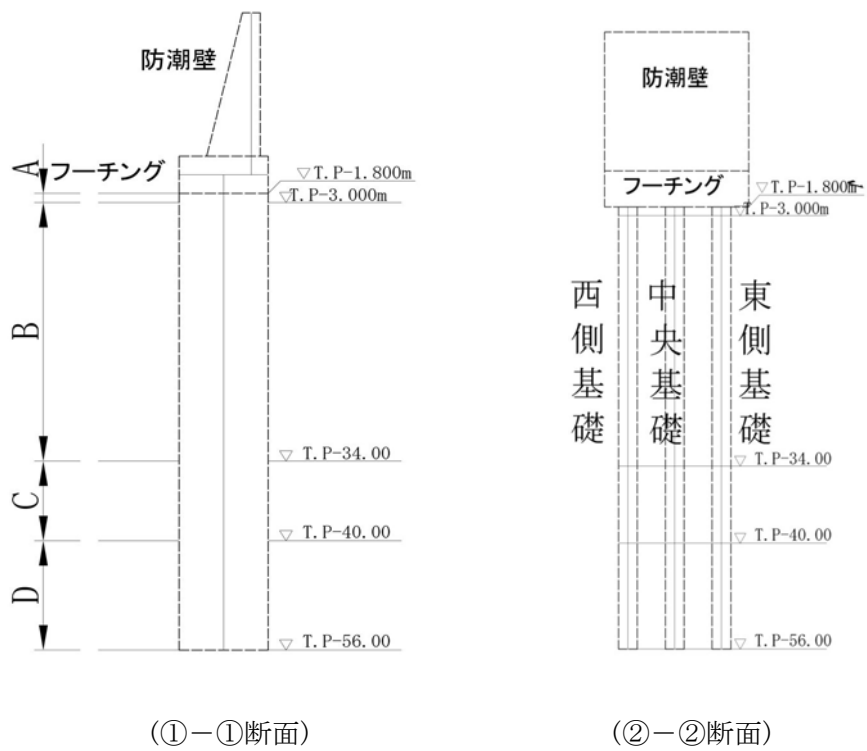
(2) 防潮堤（鉄筋コンクリート防潮壁）の照査位置図
